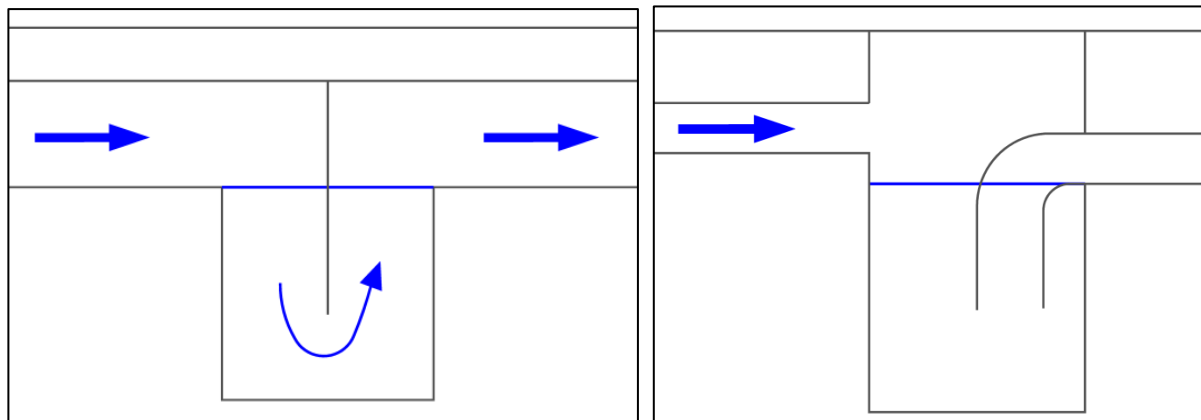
Schémas de principe de 2 exemples de zones de décantation (cloison siphonoïde et coude PVC)
